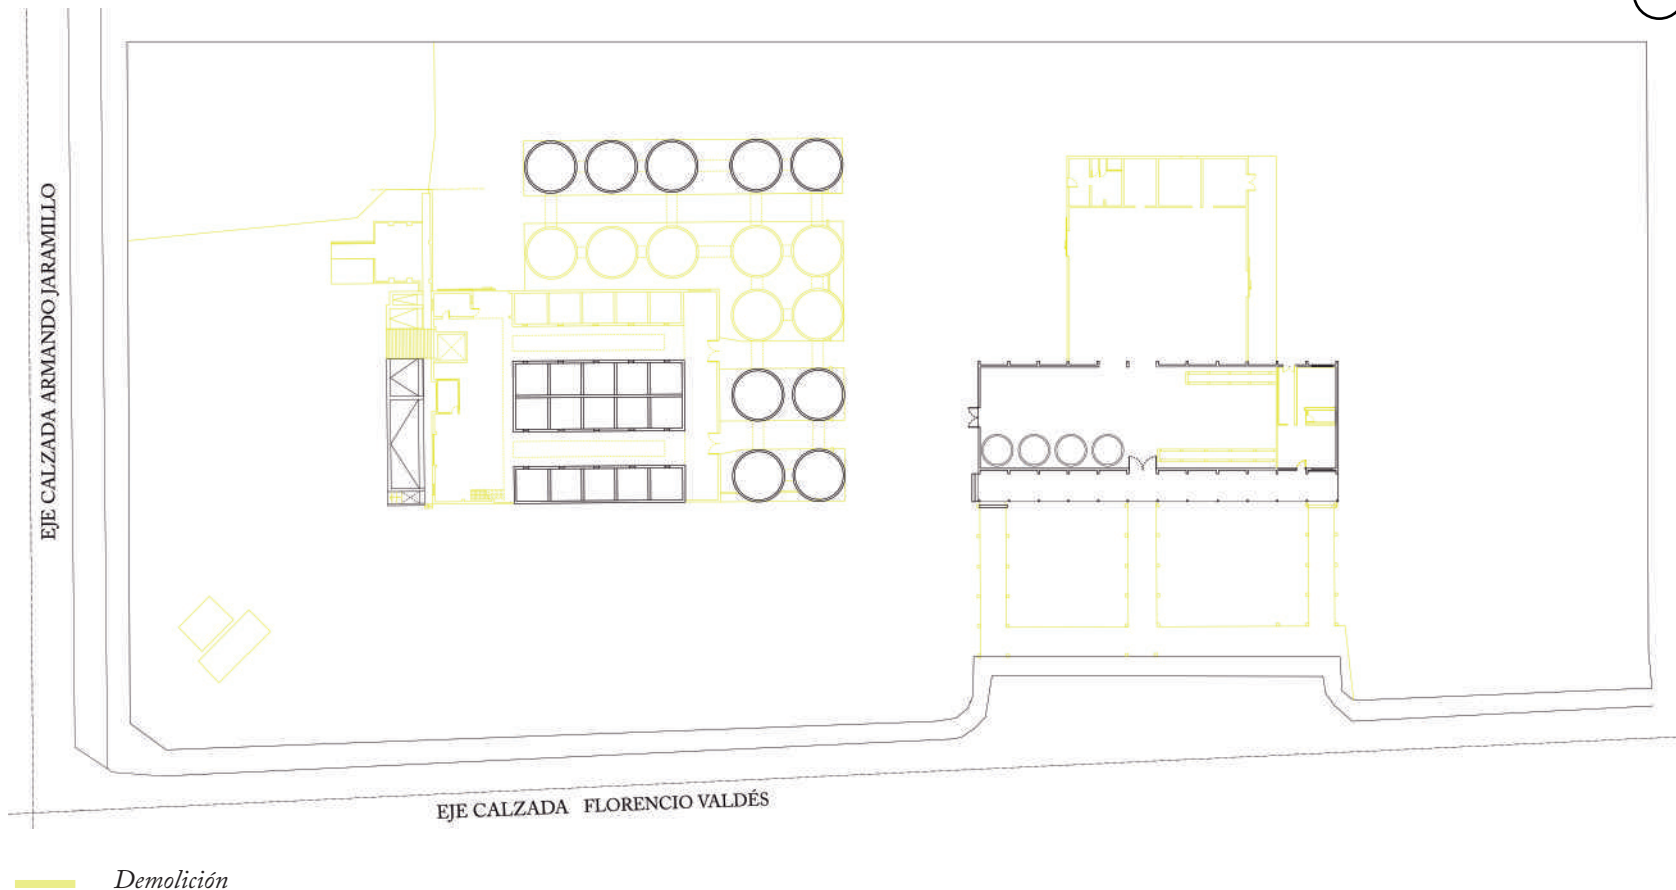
Plano Demolición Ex Planta Vitivinícola y Bodega Viña Pueblo Antiguo
